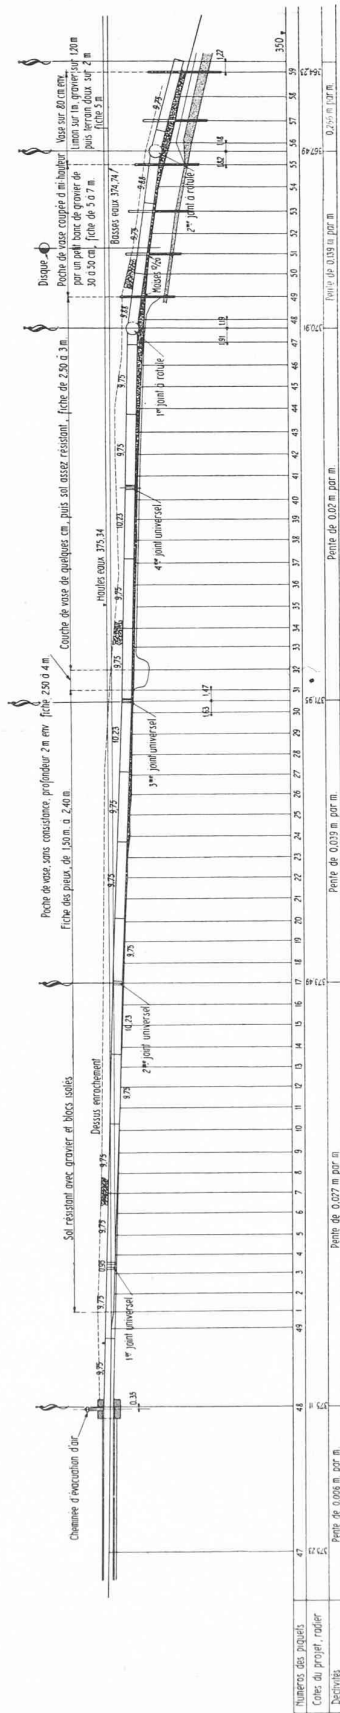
Profil en long de la conduite immergée. — Echelle 1 : 1000.
